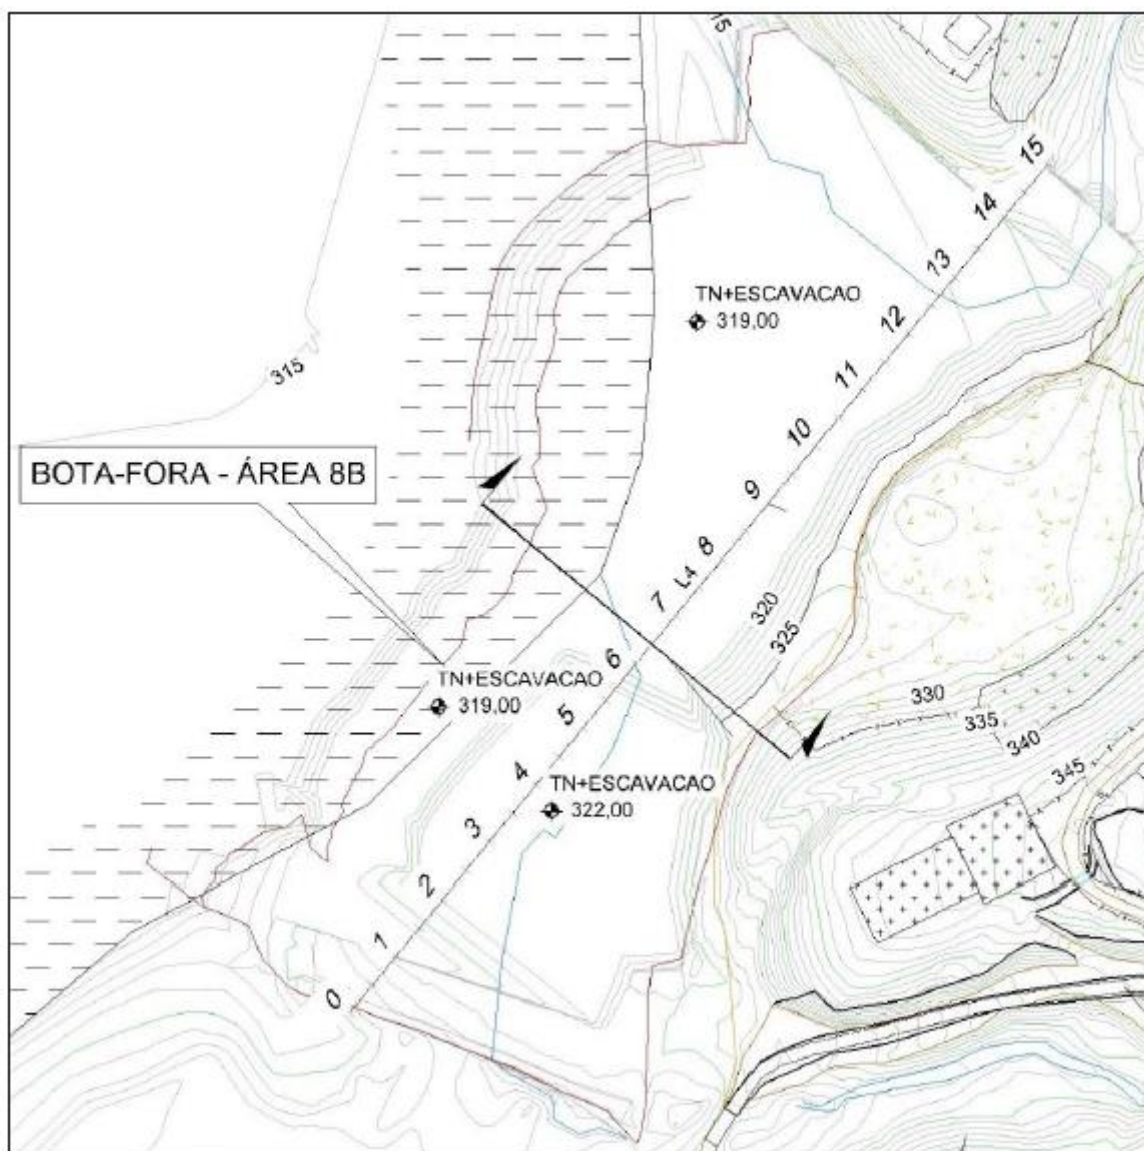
Localização em planta da seção de estudo (estaca 6+10,00 m) – Bota-fora 8B
